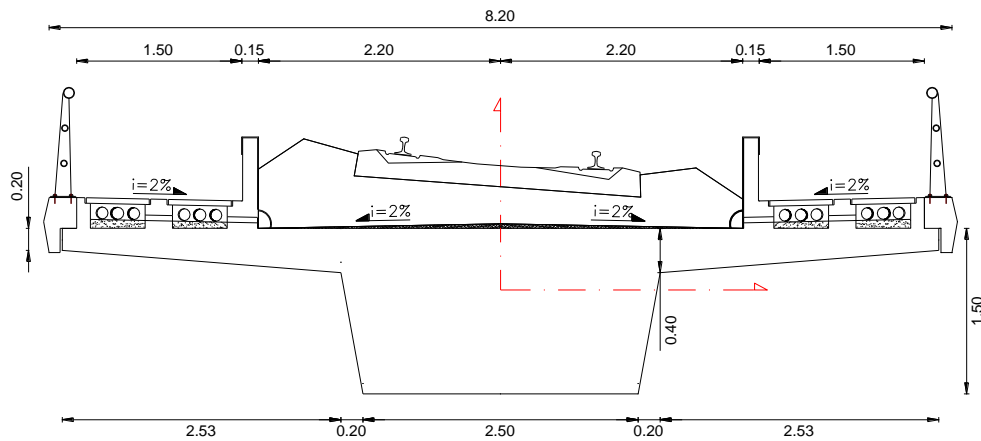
SECÇÃO TRANSVERSAL DO TABULEIRO NA SECÇÃO DE APOIO (SECÇÃO MACIÇA)
